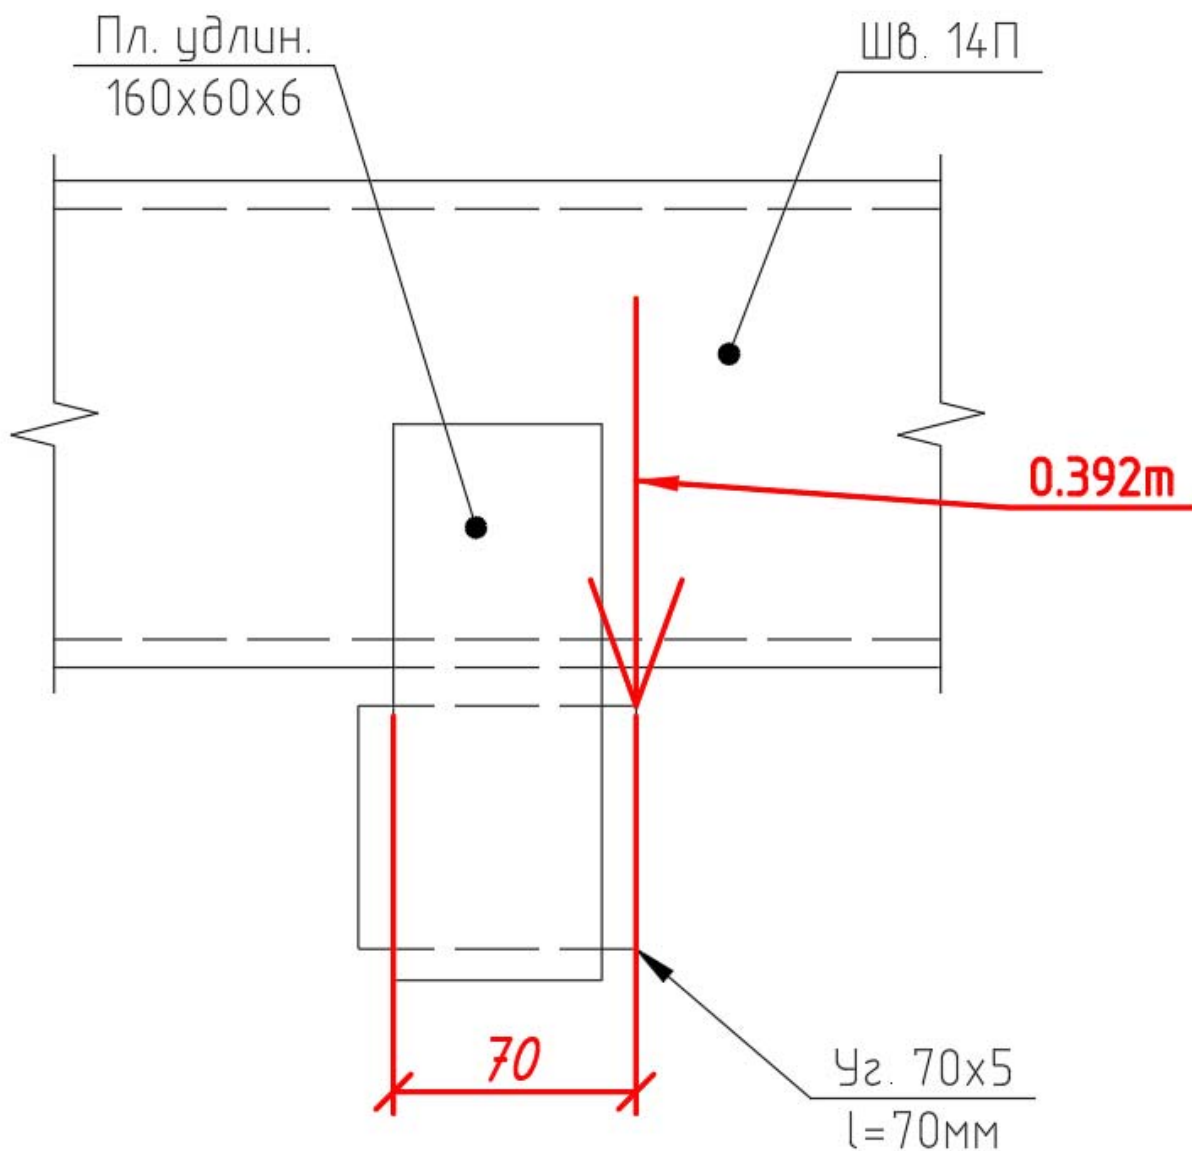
Схема вычисления момент на сварное соединение
